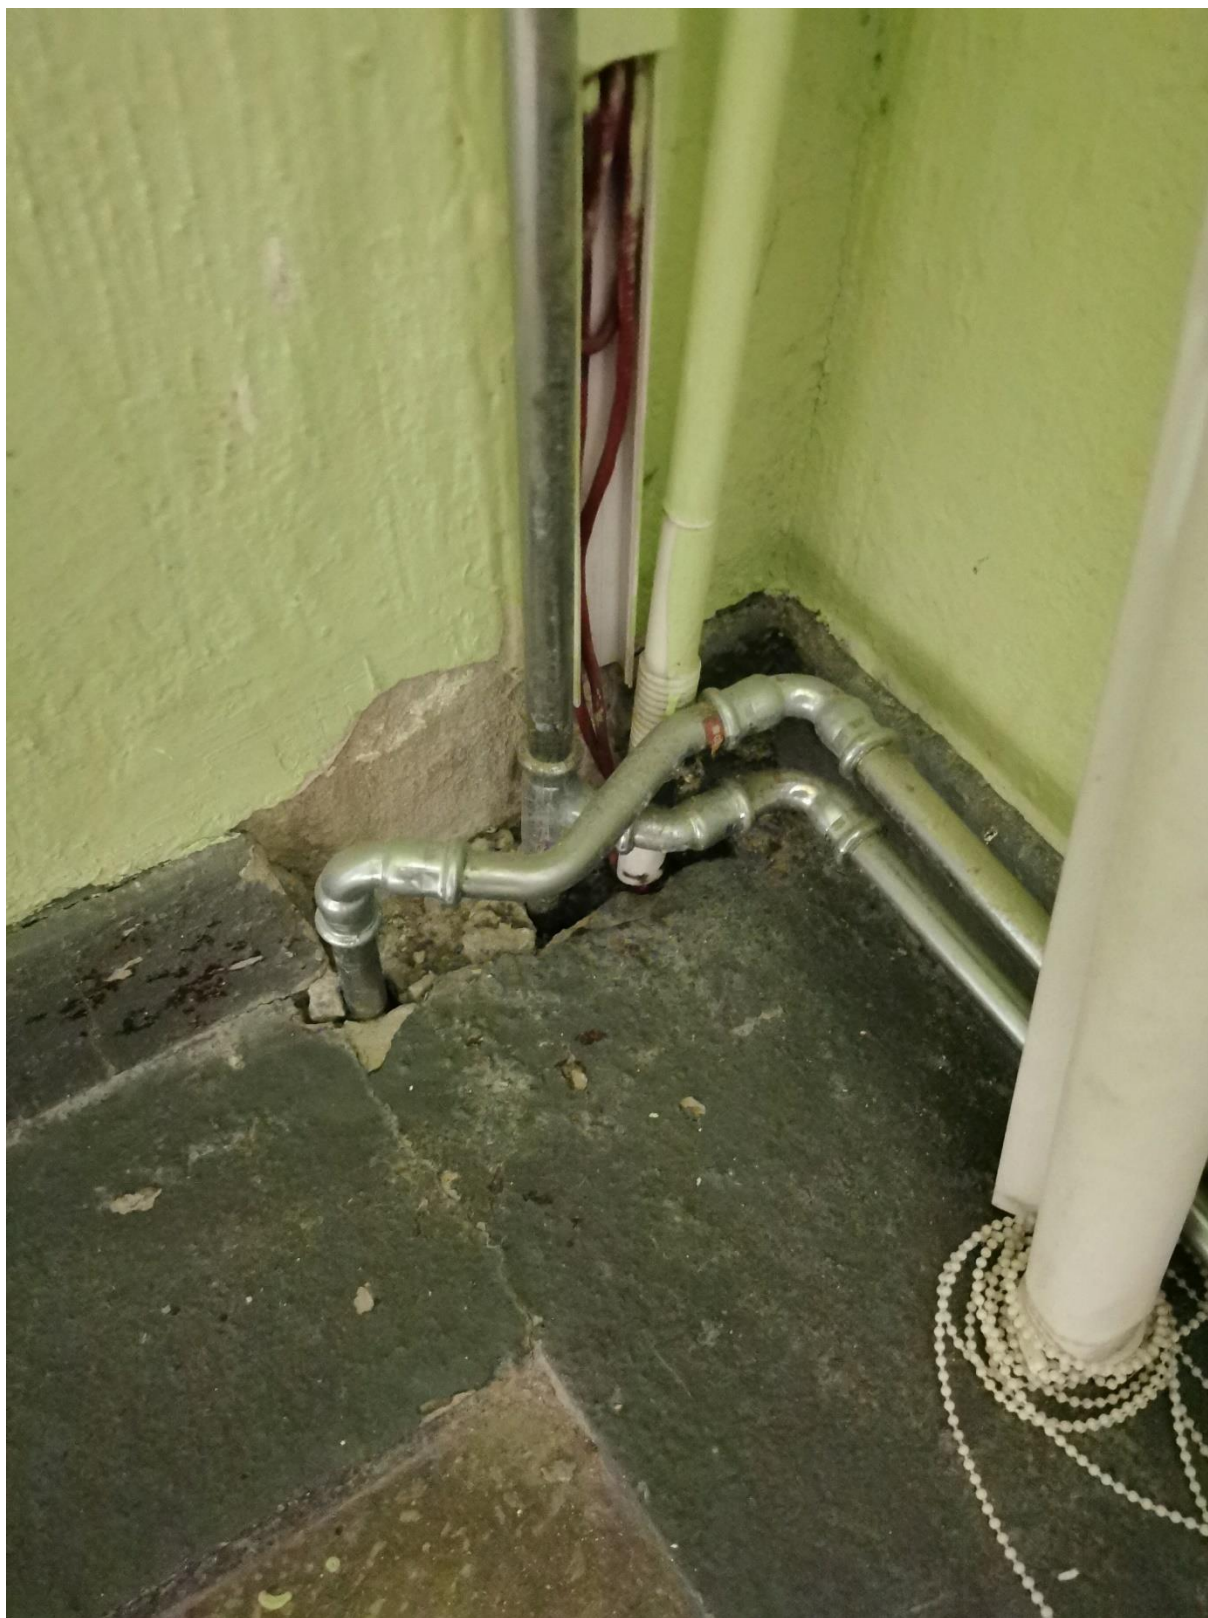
3.16B – brak odtworzenia do stanu pierwotnego przejścia instalacji przez ścianę
